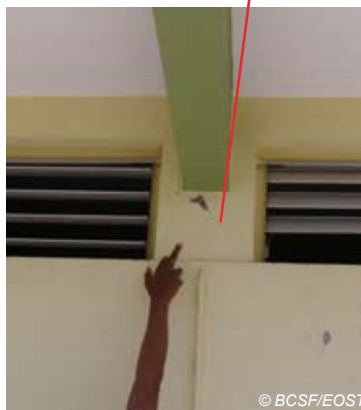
Rivière Pilote - Collège Jacques Roumain - bâtiment D - fissure en X (effet "poteau court").
